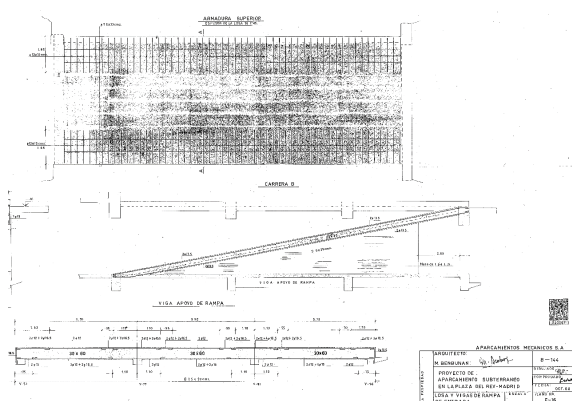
Detalle de losa de rampa de acceso a aparcamiento
